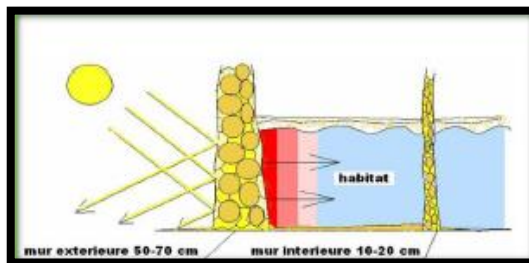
Construction des murs en pierre, source :<http://tafilelt.com/>
